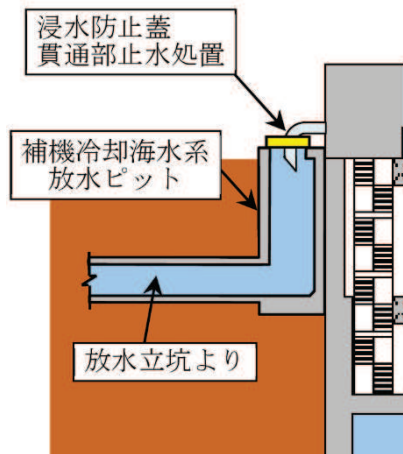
3号機 放水立坑 浸水対策配置図 (A-A 断面図)
